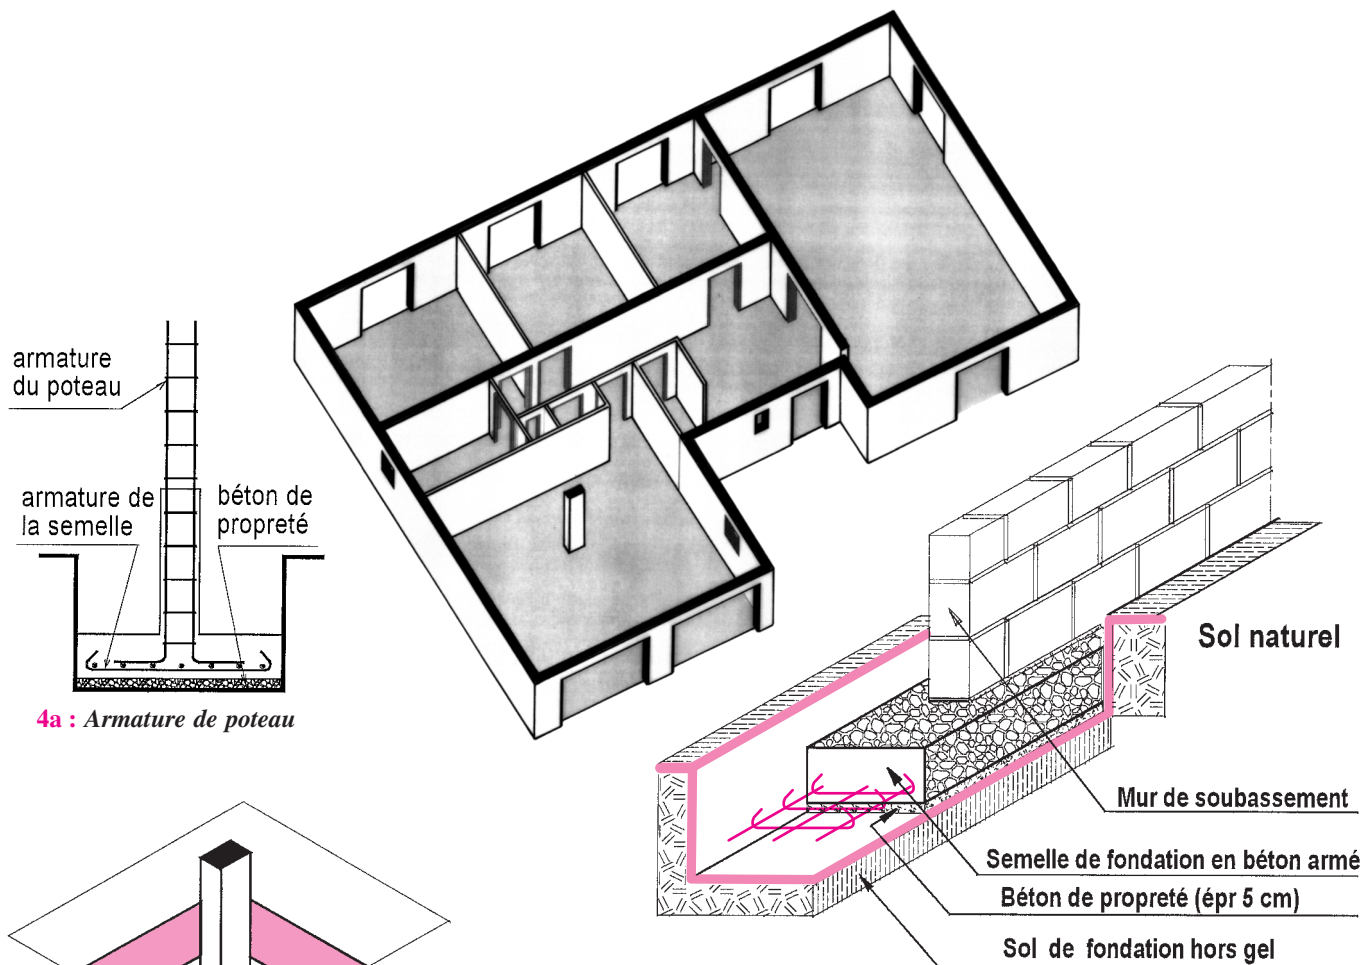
visualisation de la structure porteuse du rez-de-chaussée et de l'emprise des fondations sur le terrain
